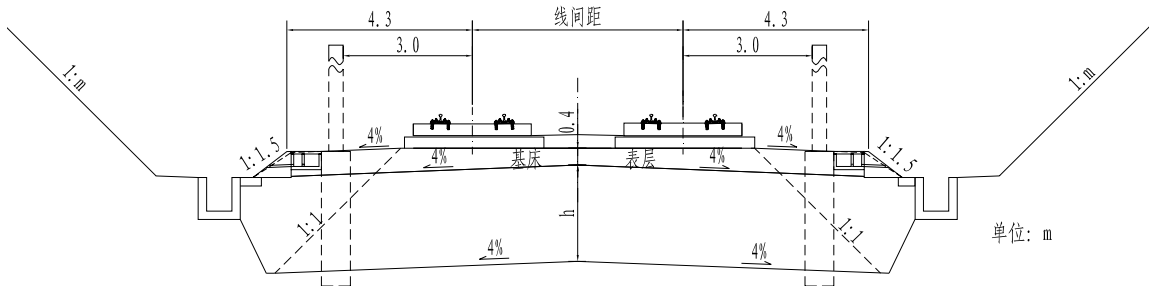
无砟轨道双线非硬质岩路堑标准横断面示意图
